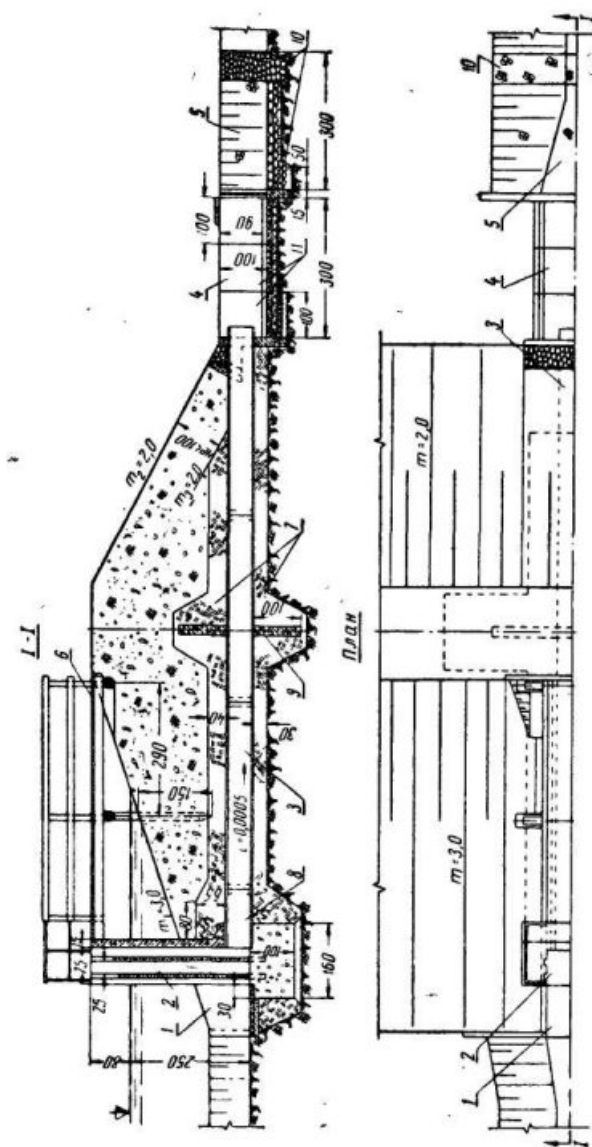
Донний водоспуск нагульних ставків на напори до 5 м:
